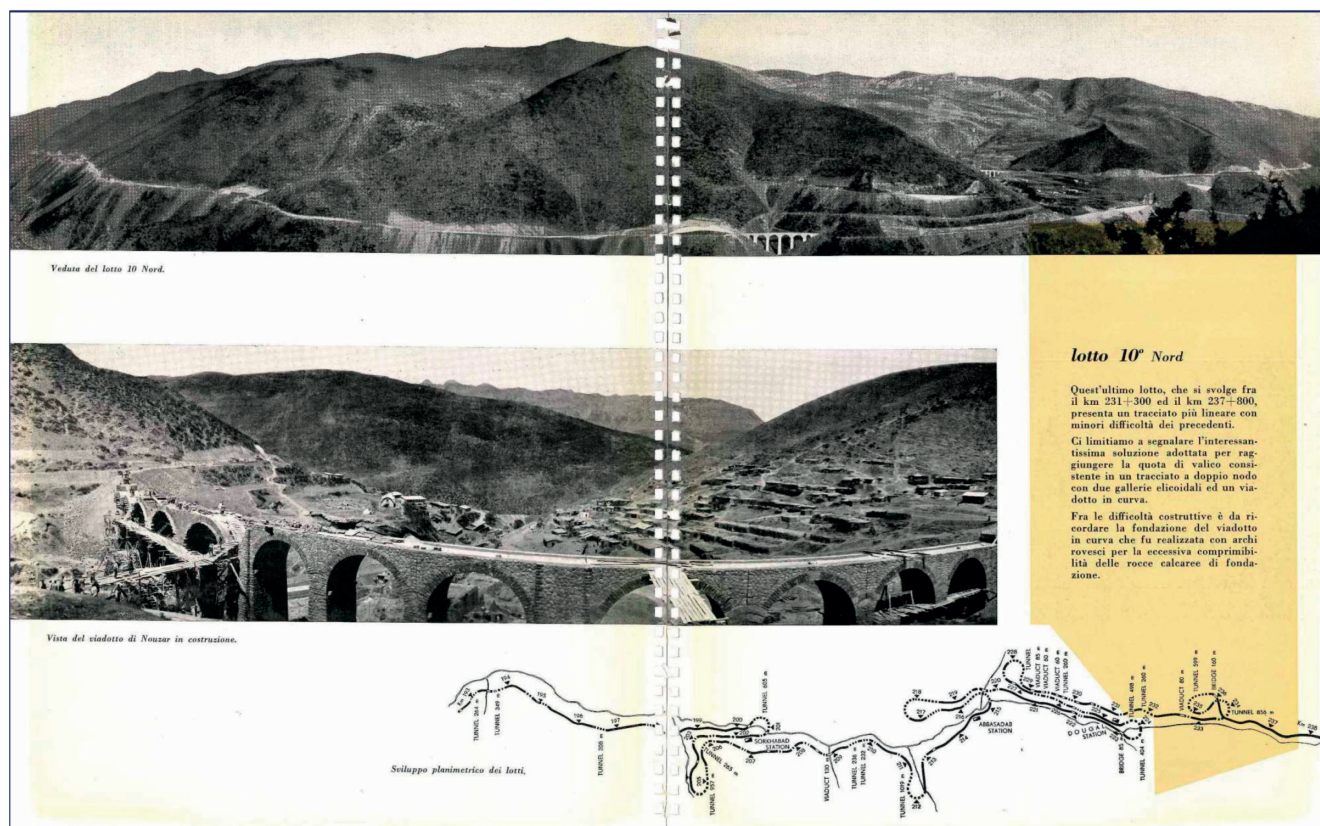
Ferrovia transiraniana, sezione Nord: lotto 10 [1].
